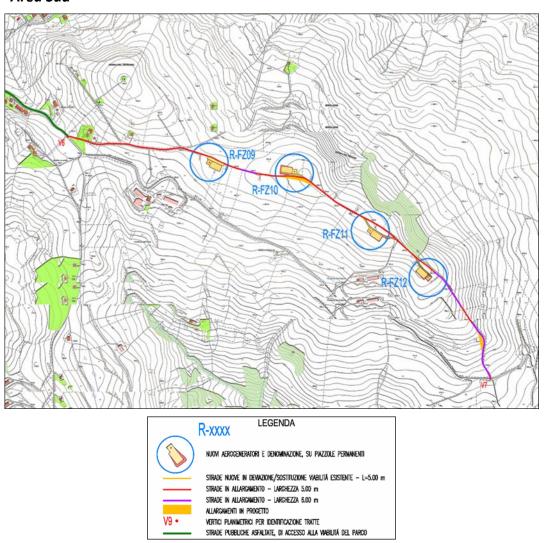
Stralci planimetrie d'impianto con viabilità di accesso agli aerogeneratori
